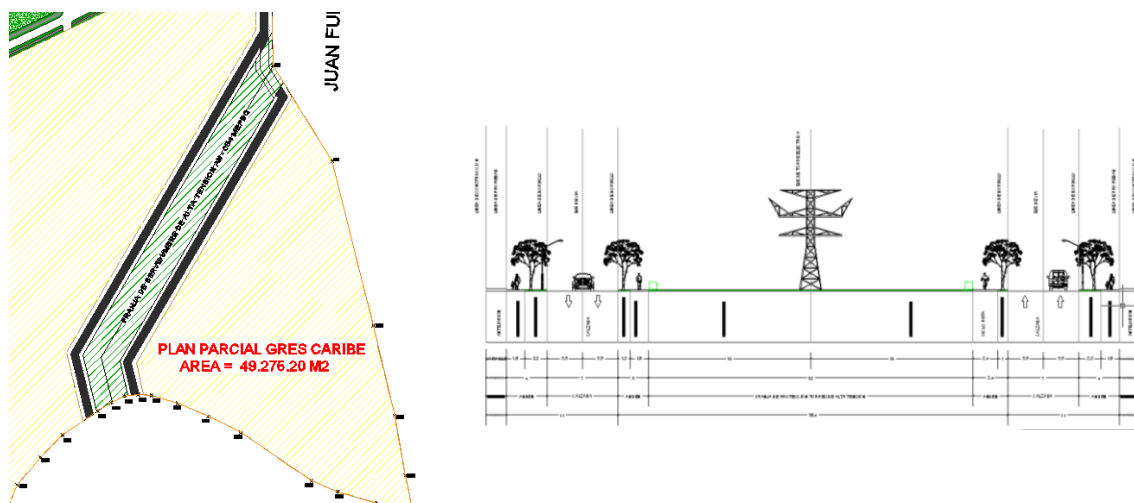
Corte transversal: área de servidumbres por líneas de alta tensión
